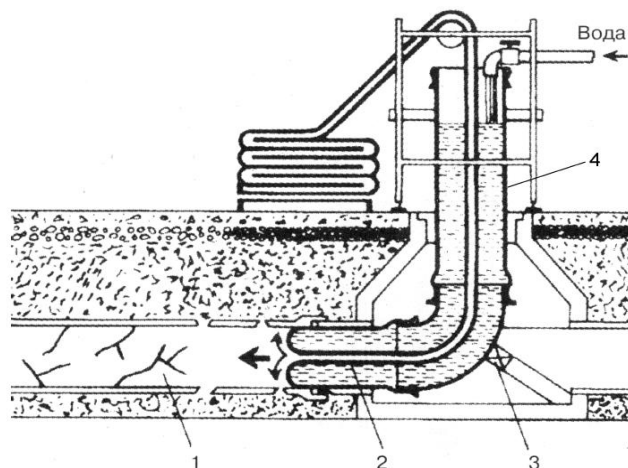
Схема введения на ремонтный участок скрученной в рулон оболочки в виде чулка: 1 – восстанавливаемый трубопровод; 2 – защитное покрытие в виде выворачивающегося наружу чулка; 3 – упор; 4 – сборно-разборный стояк из пластмассовой трубы
